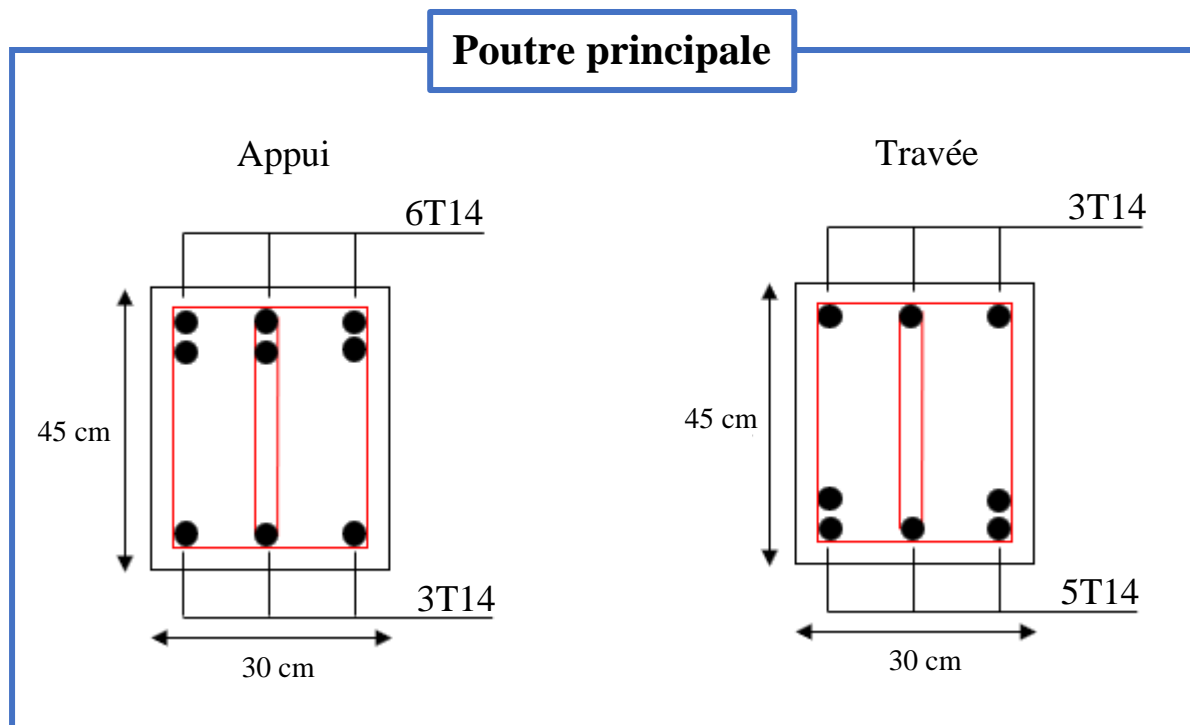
Schéma de ferrailage des poutres principales (RPA99/v03).
